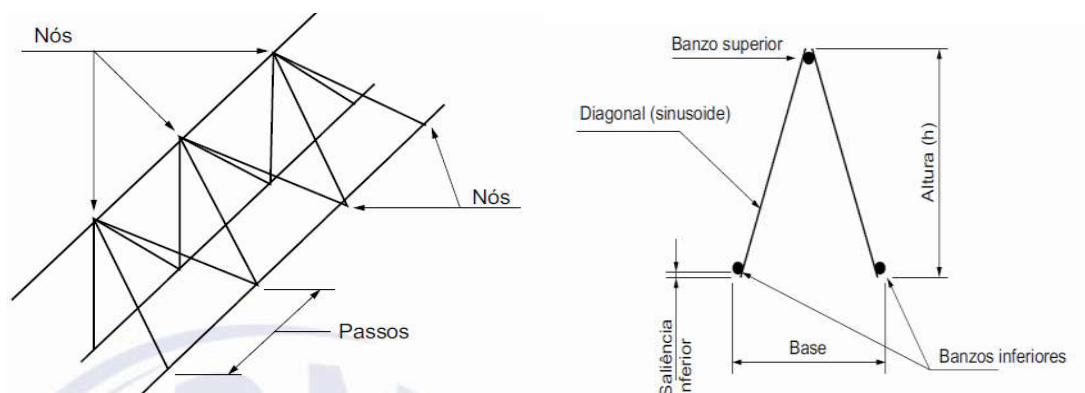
Dimensões e tolerâncias para vigotas treliçadas
